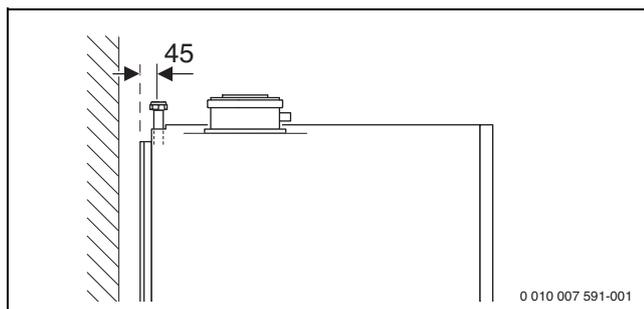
Anschlussmaße des Zubehörs AS-V1/Vertikales Anschluss-Set (Maße in mm)
